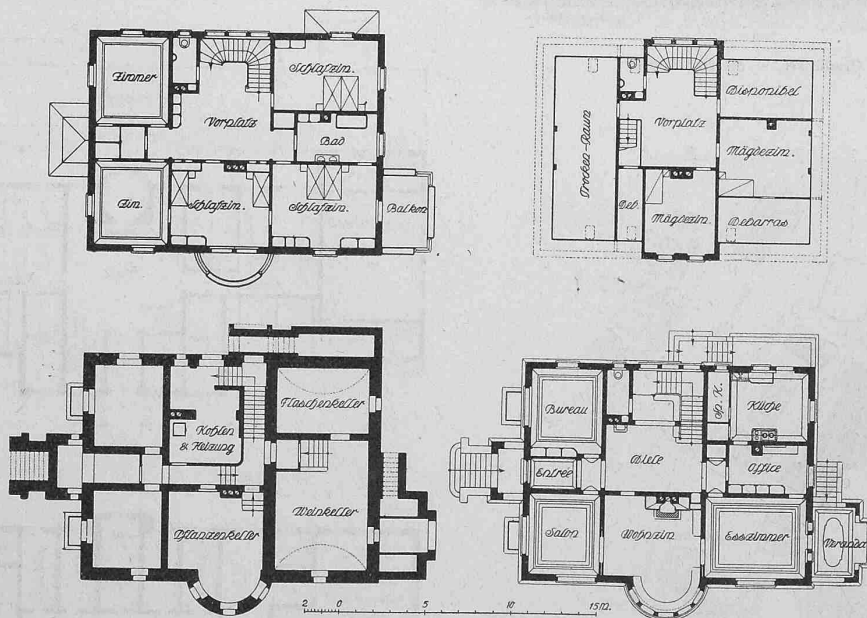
bis 4. Grundrisse des Landhauses R. Eymann in Langenthal.
